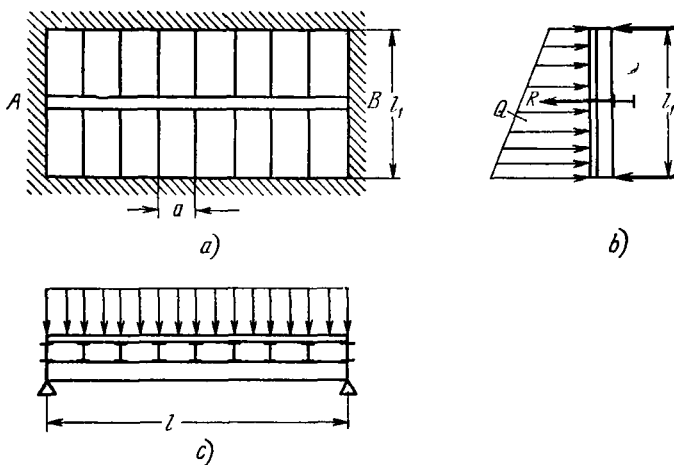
Вертикальные балки, поддерживаемые одной поперечной балкой.
